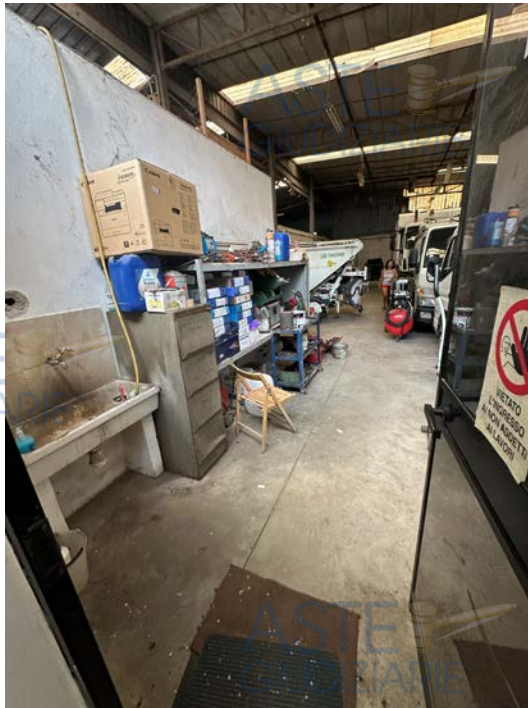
Porta di accesso dall'ufficio al primo corpo di fabbrica
